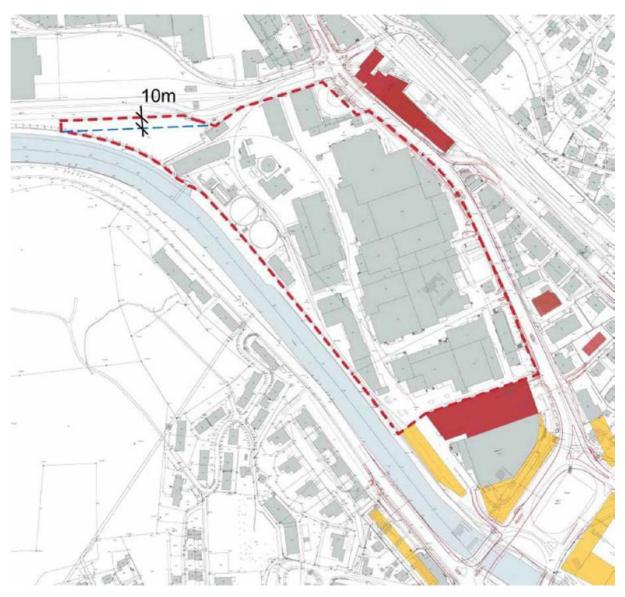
Übersichtsplan mit Perimeter des Planungsgebiets (rot: angrenzende Projekte; gelb: angrenzende Planungen; blau gestrichelt: erweiterter Grenzabstand 10 m auf der Parzelle der Gemeinde Emmen)
